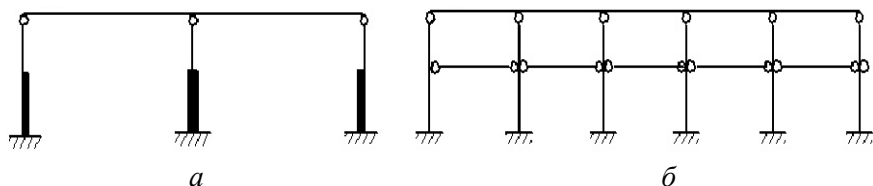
Основна схема поперечної рами (а) та поздовжньої рами (б)
